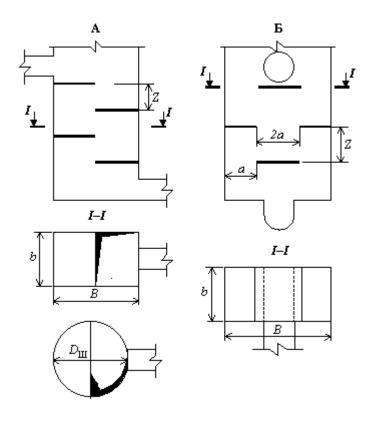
Схемы к расчету многоступенчатых шахтных перепадов схема ${\bf A}-{\bf c}$ круглой водопропускной формой; схема ${\bf F}-{\bf c}$ прямоугольной водопропускной формой
